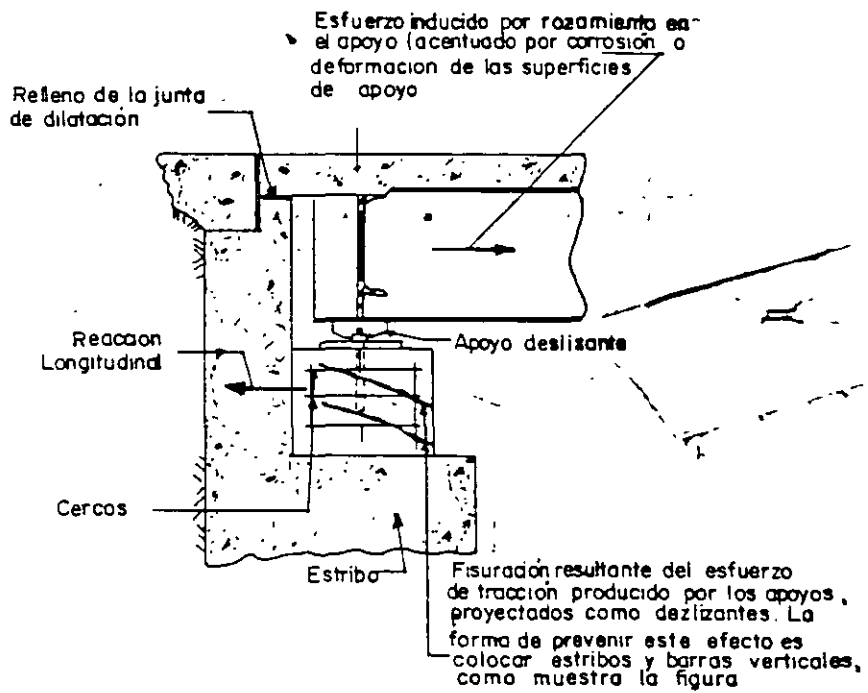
FIG. II - IIa - Fisuración de un apoyo de viga
